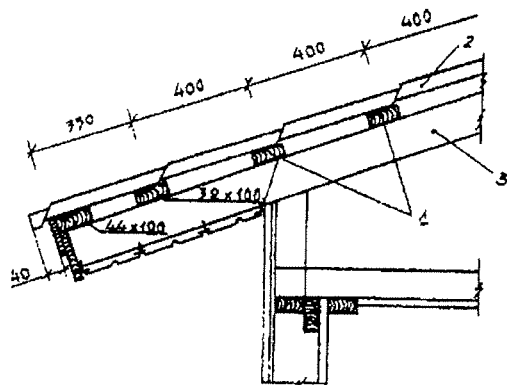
Конструкция обрешетки под кровлю из металлочерепицы:
